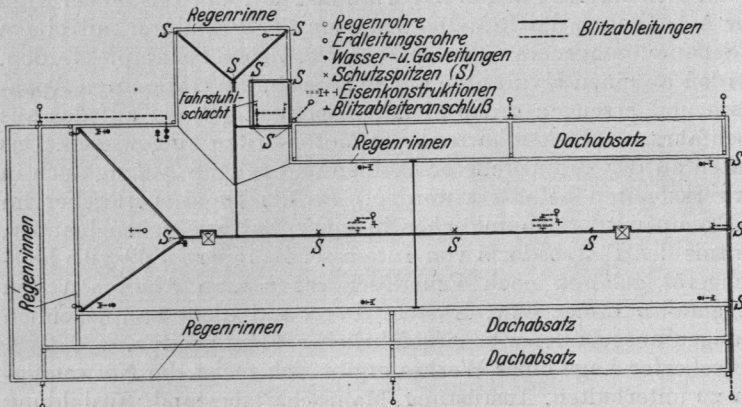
Blitzschutzanlage eines Stockwerksbaues.
